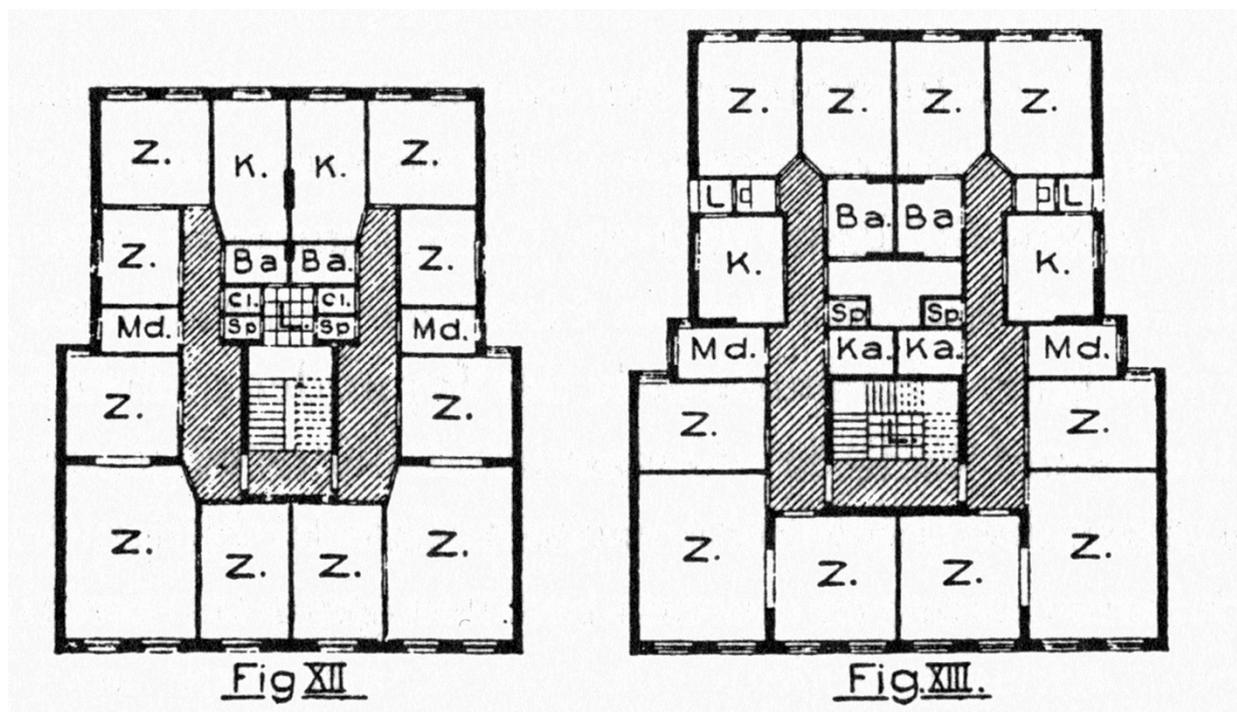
Beispiel T-Grundriss, Schlitzbau, aus Hipp, Hamburg, S. 53
